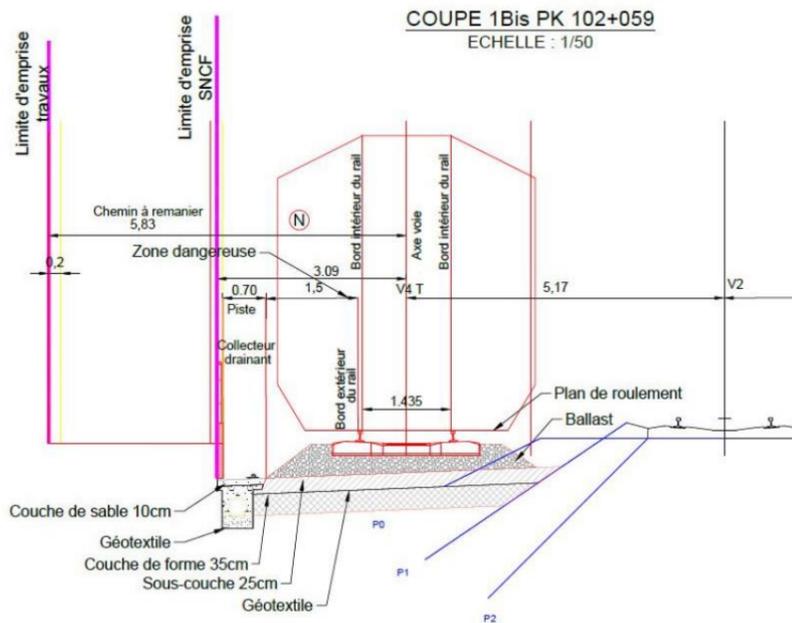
coupe voie 4 tiroir Carnoules avec collecteur drainant (Systra, 2021)
